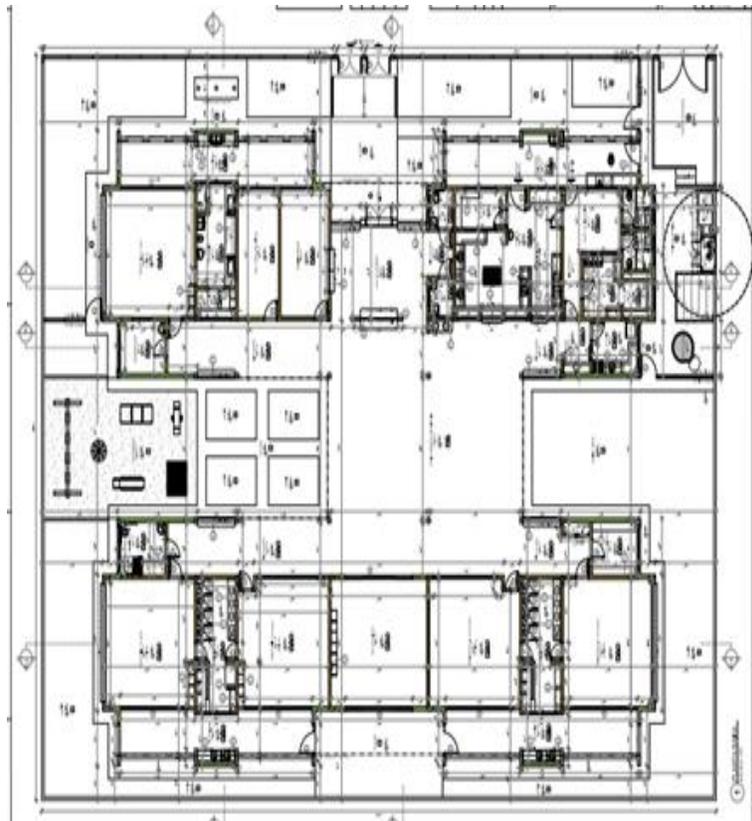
Projeto padrão FNDE – Planta Baixa.
